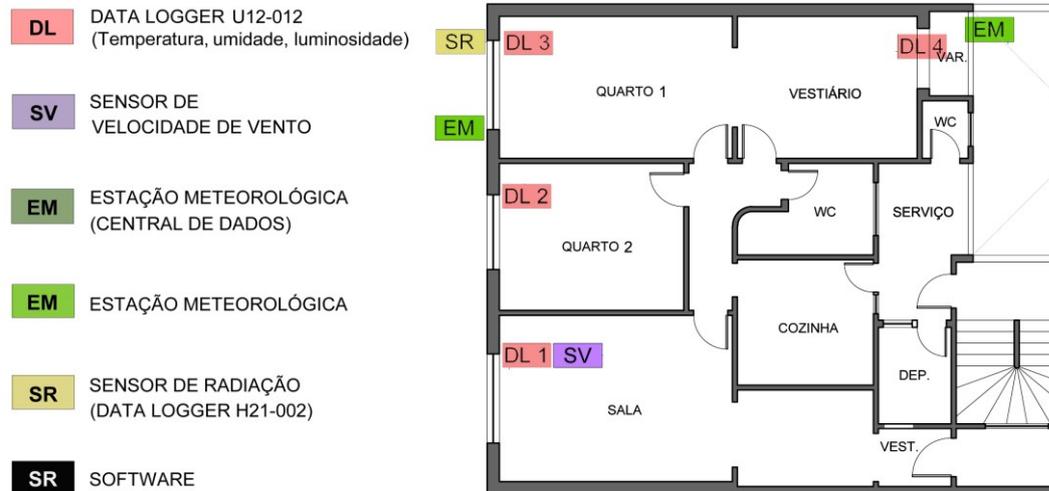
Planta do apartamento adotado como modelo com indicação dos equipamentos (fonte: Concepção Autor e Desenho Foadelli).
